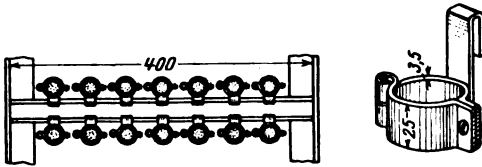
Kabelbefestigung mit Schellen, die auf Stege gehakt werden.
